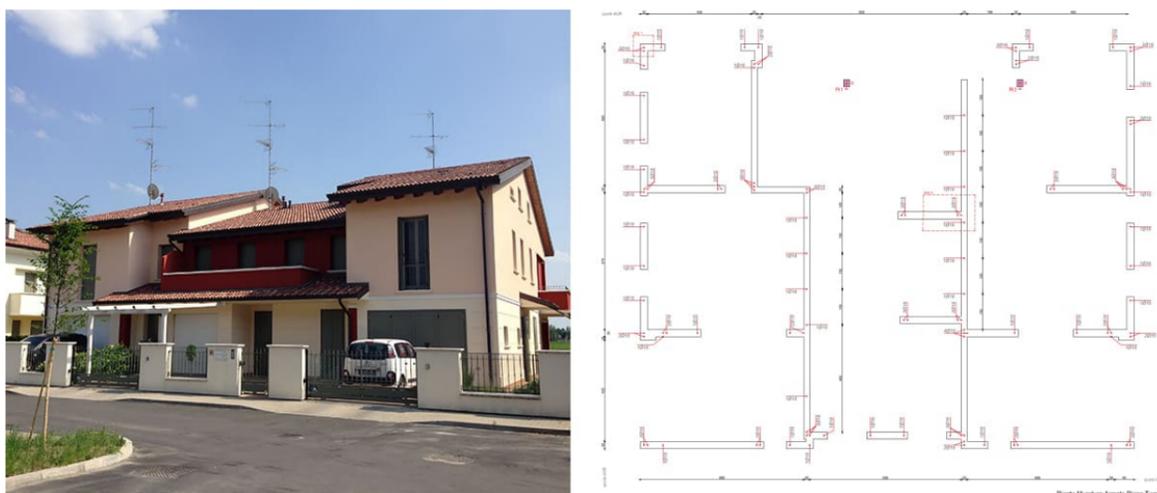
Struttura mista (muratura armata e telaio in c.a.): foto fronte strada (sx) e pianta piano primo (dx).
